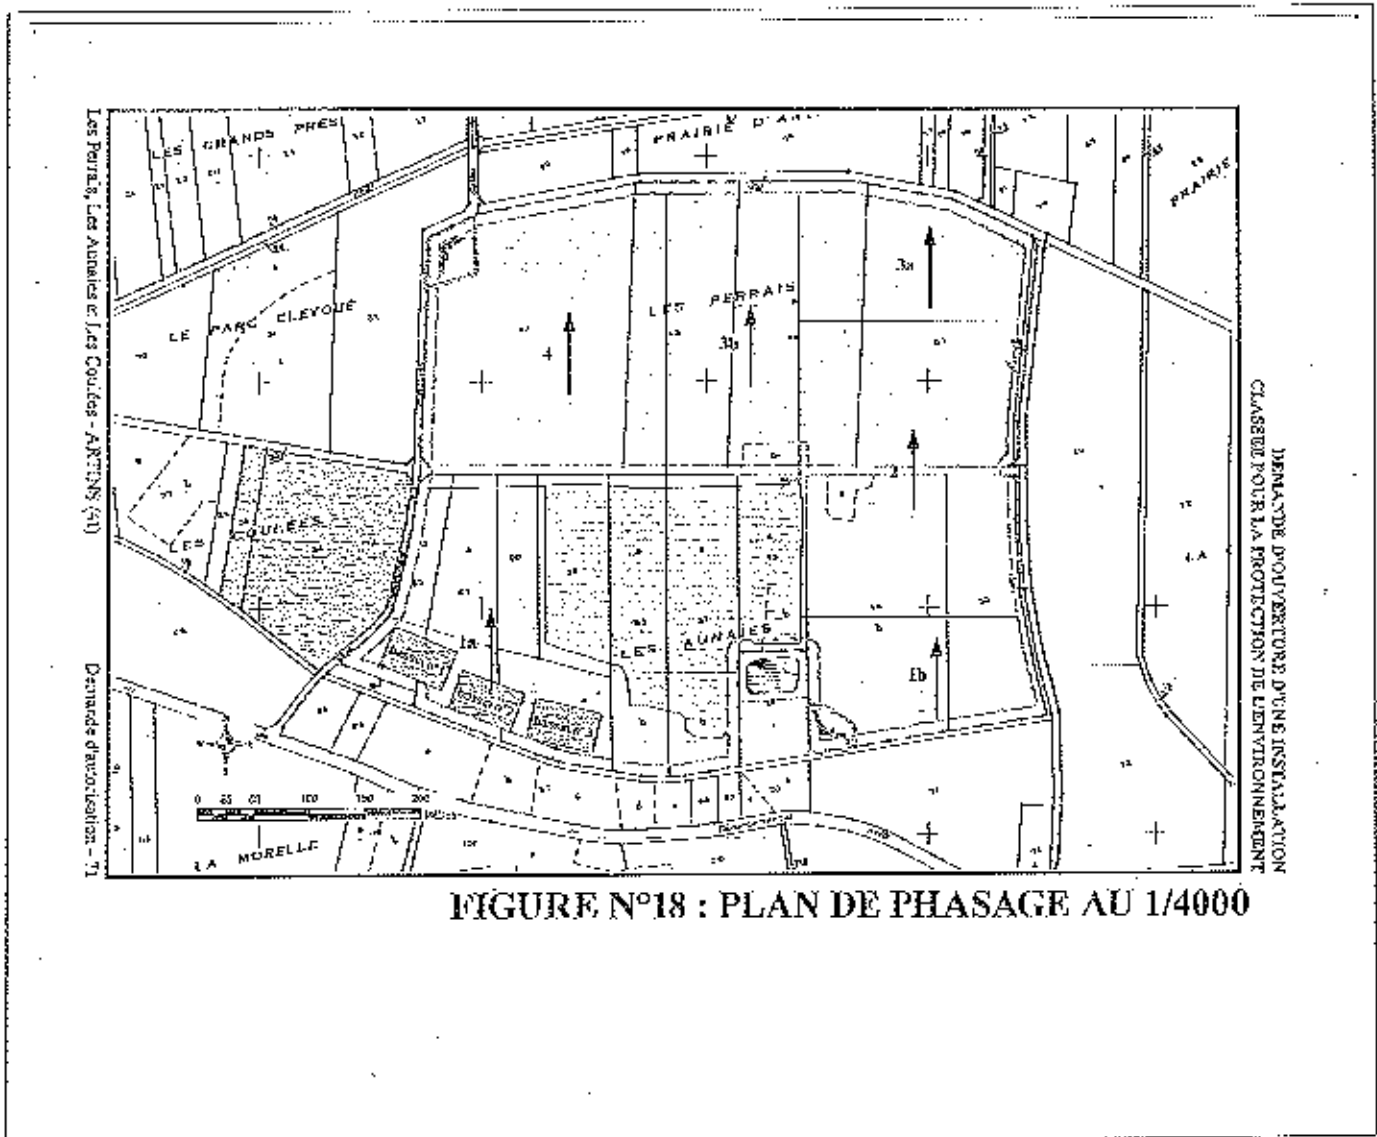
PLAN DE PHASAGE AU 1/4000
